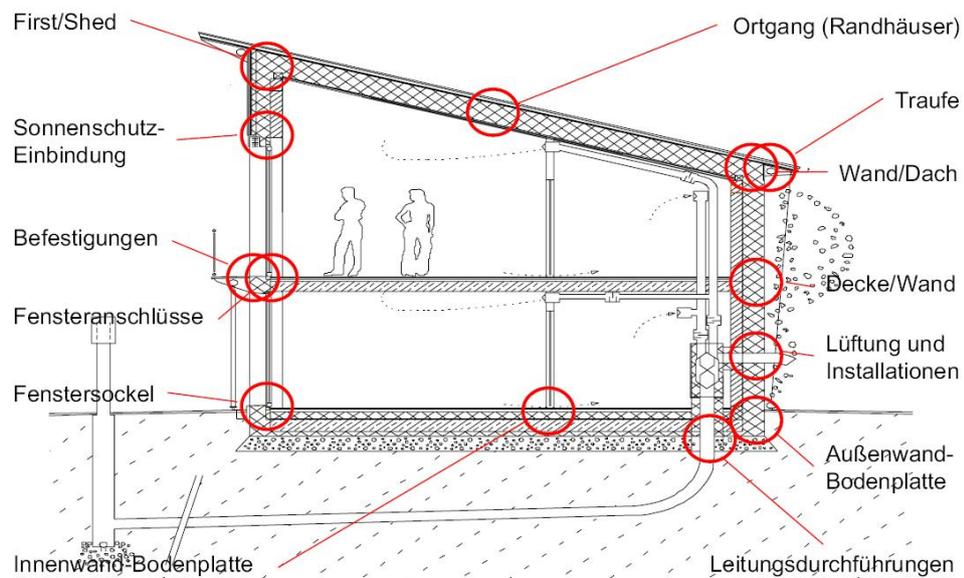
Beschreibung: Besonders Wärmebrücken-gefährdete Bauteile
